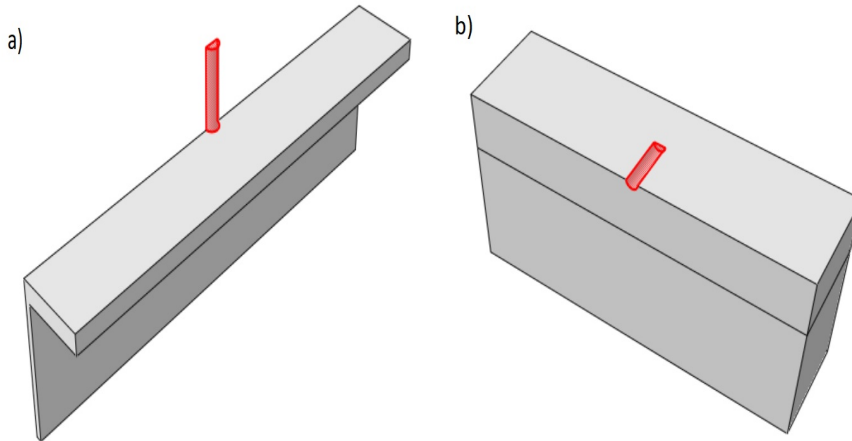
a) Beton döşeme yüzeyi b) Çelik profil yüzeyi.
